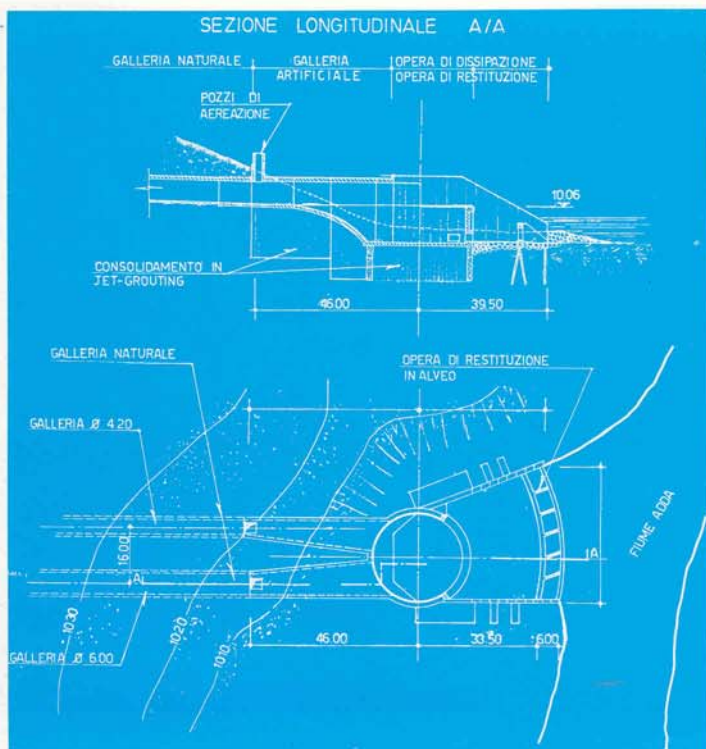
(a sinistra) - Planimetria e sezione dell'imbocco di valle
